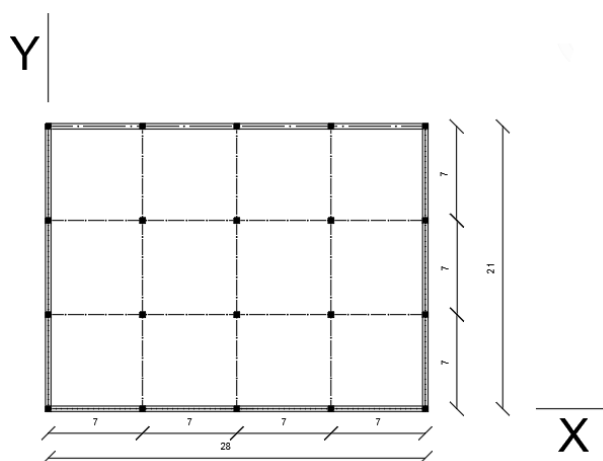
Disposição em planta dos elementos estruturais modelo E4A
